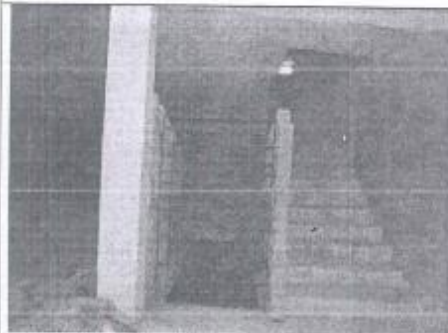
Vista de las escaleras de acceso al sótano y al segundo piso de la edificación.
